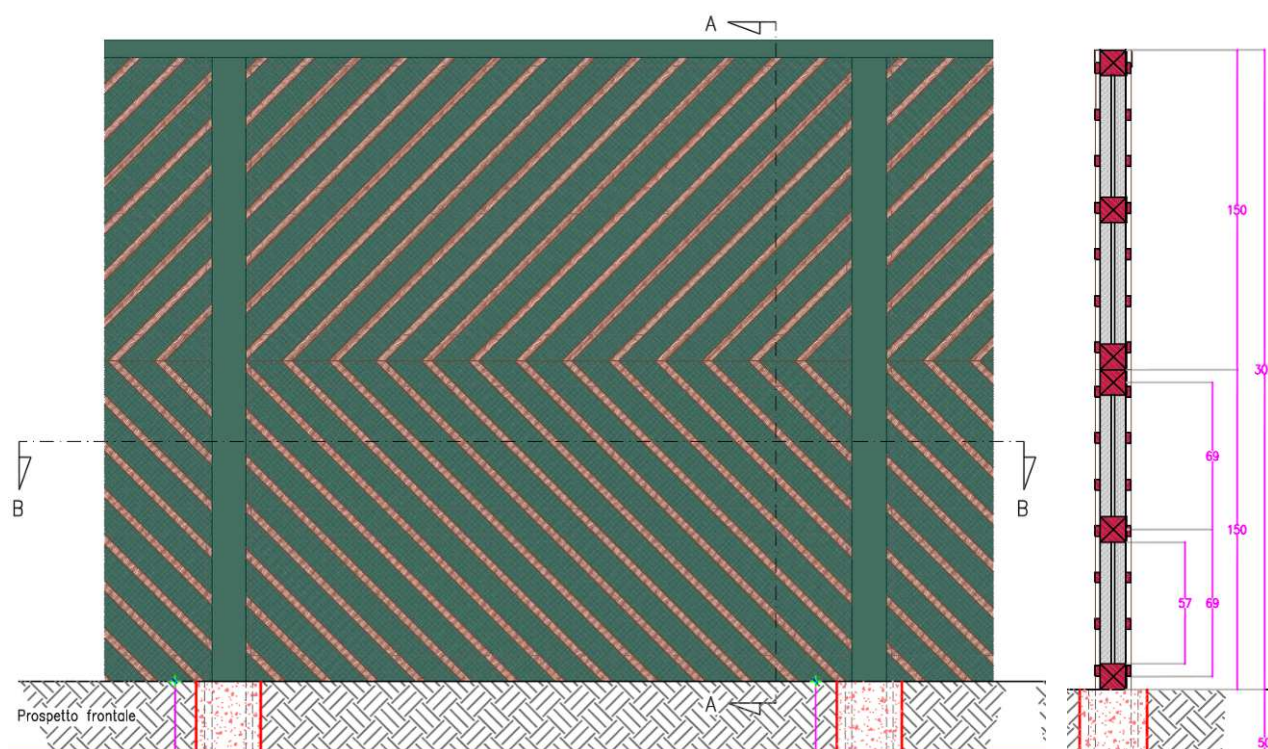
BARRIERA ACUSTICA IN LEGNO: VISTA PROSPETTICA E SEZIONE VERTICALE
